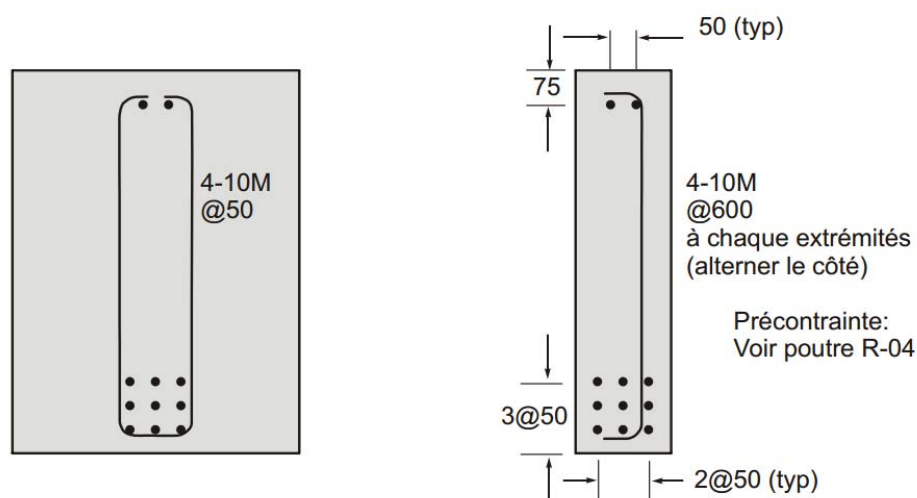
Croquis du ferrailage des poutres R07 et R08
